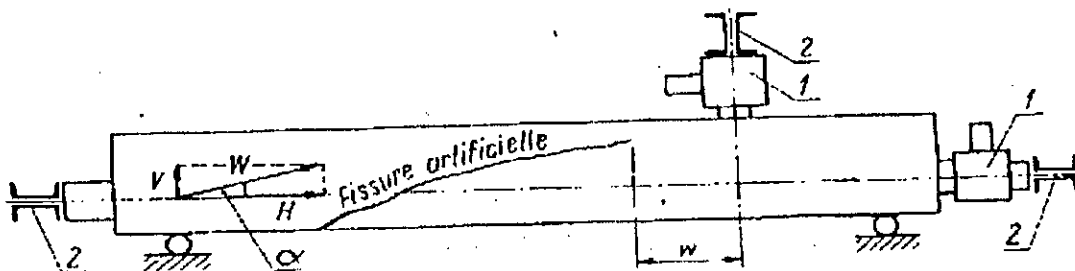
Exemple d'une poutre en béton avec une fissure artificielle dans les essais de BORICHANSKI.
